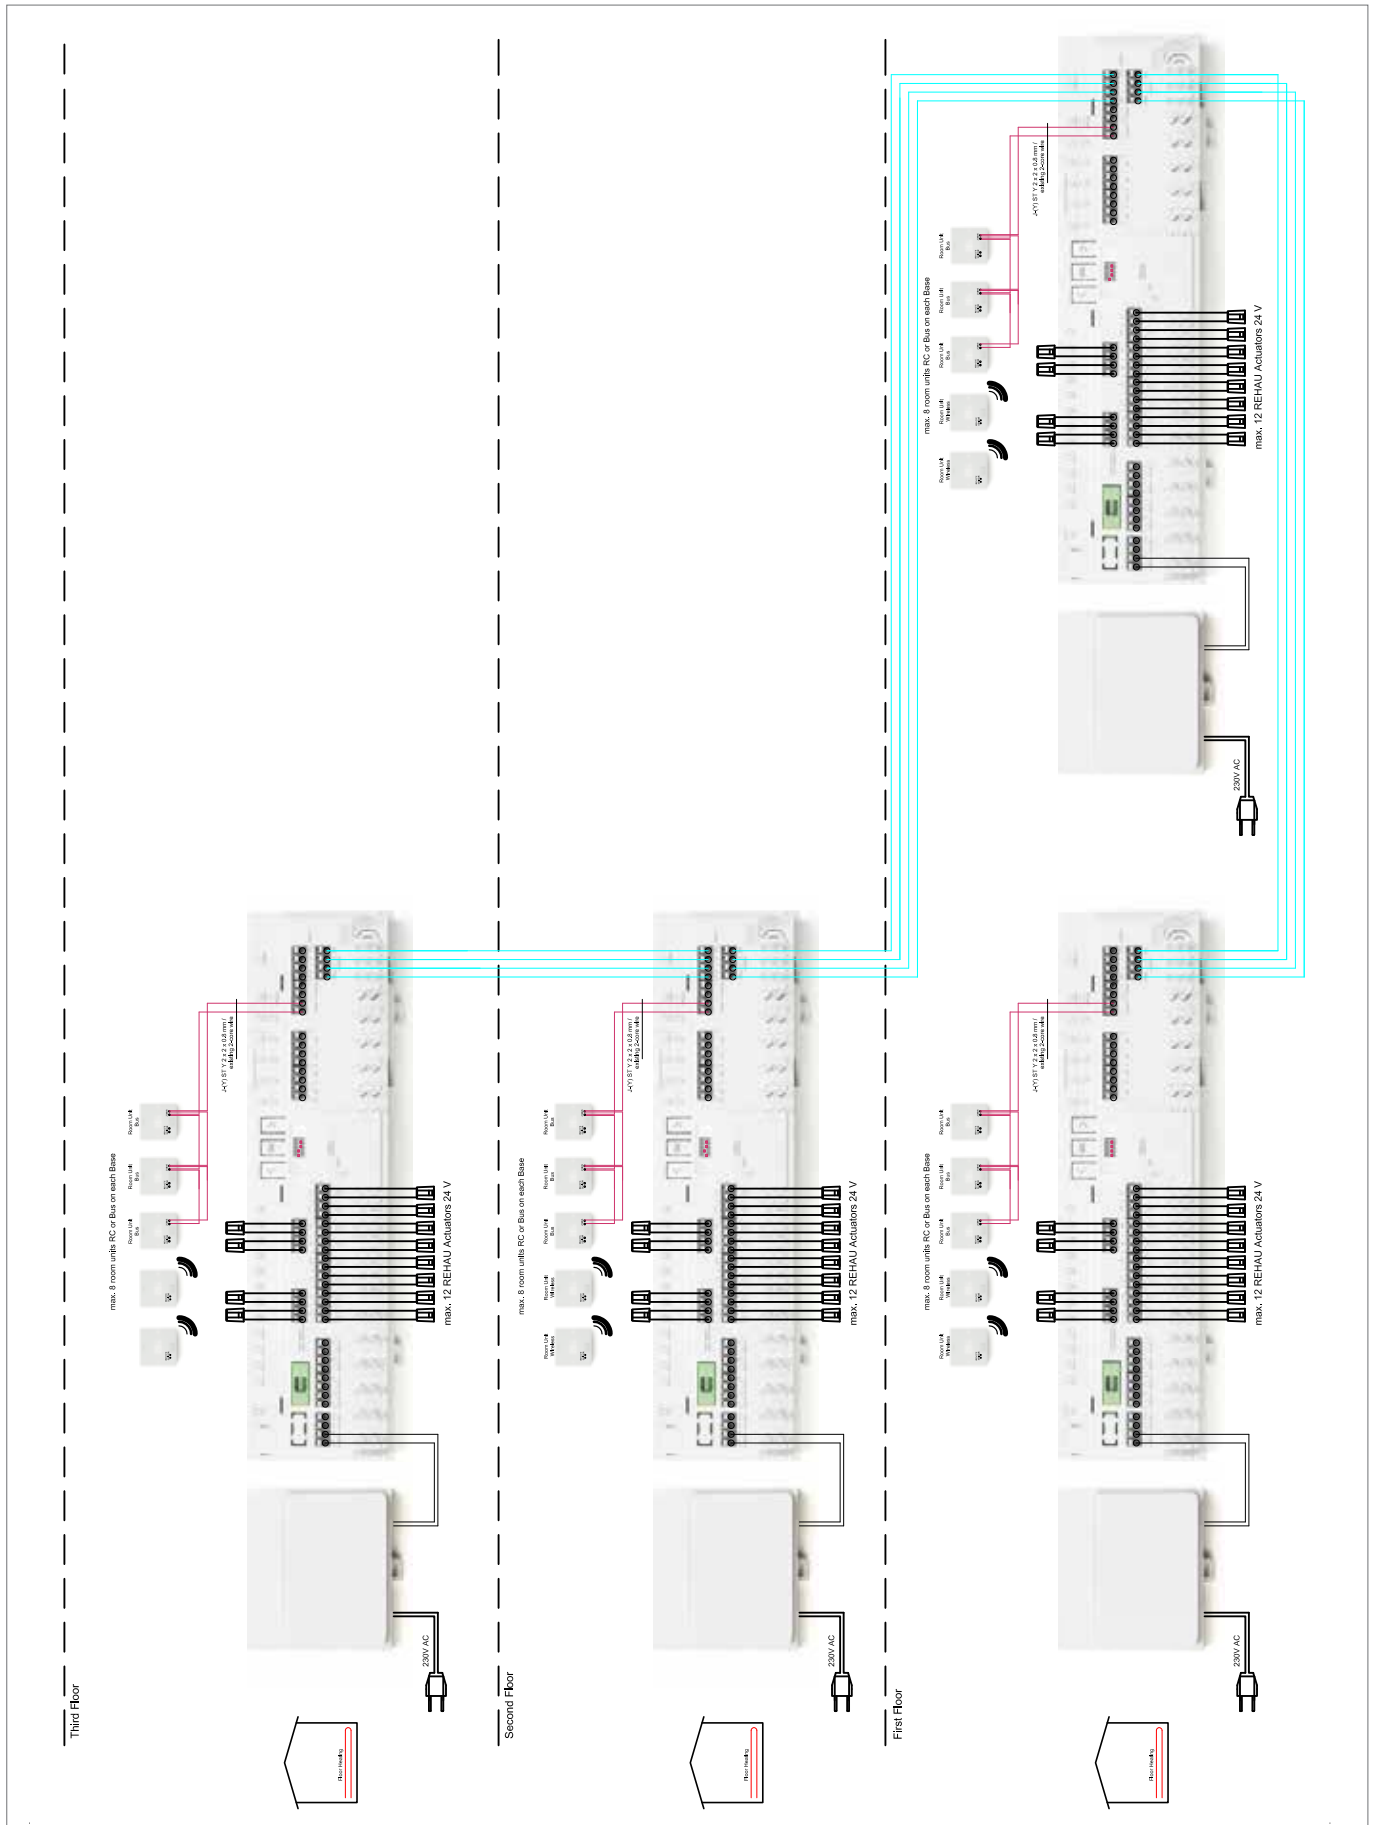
Grande impianto con regolazione della temperatura ambiente – Riscaldamento a pavimento – Edificio adibito ad uffici
